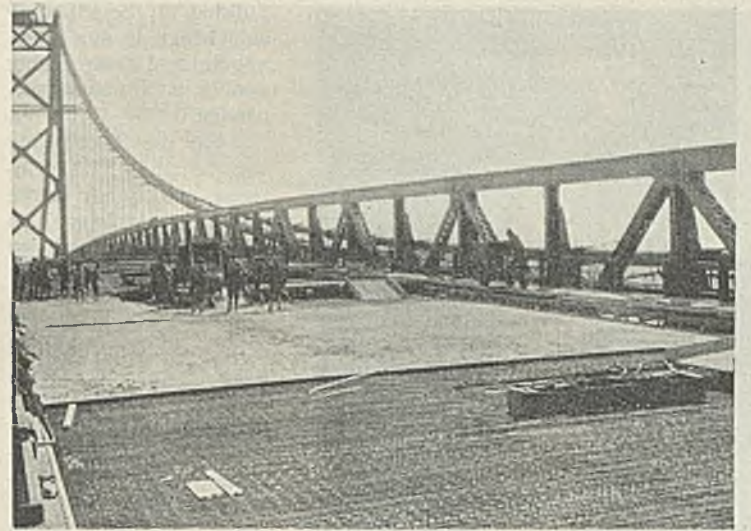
Im Vordergrund Bewehrung, im Hintergrunde Betonieren des aufgehängten Brückenteils.
